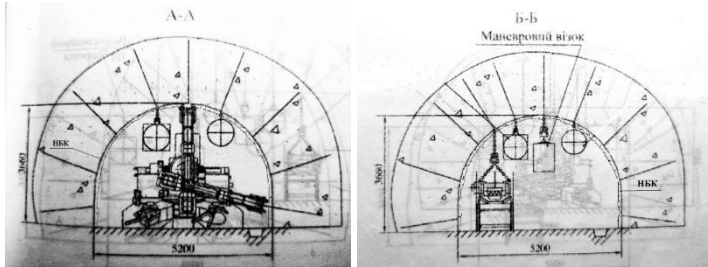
Перетини виробки аркової форми з анкерно-набризкбетонним кріпленням
